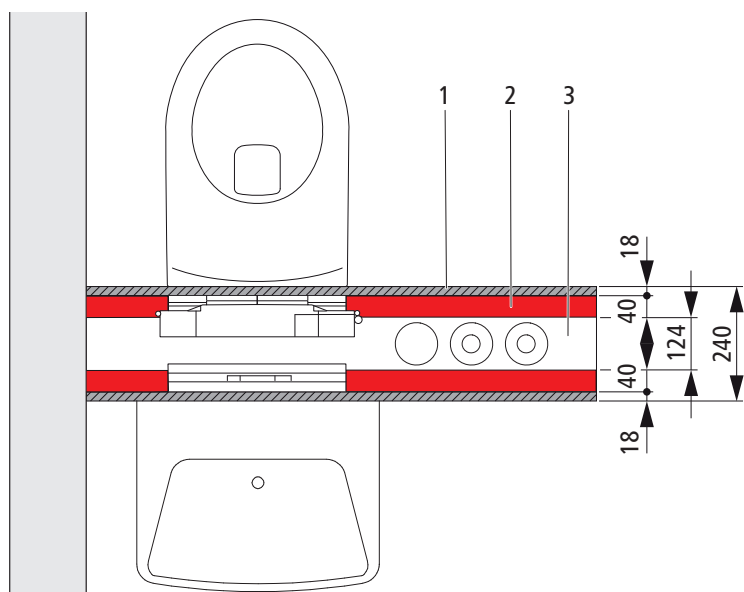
Vista dettagliata sezione parete divisoria 240 mm
